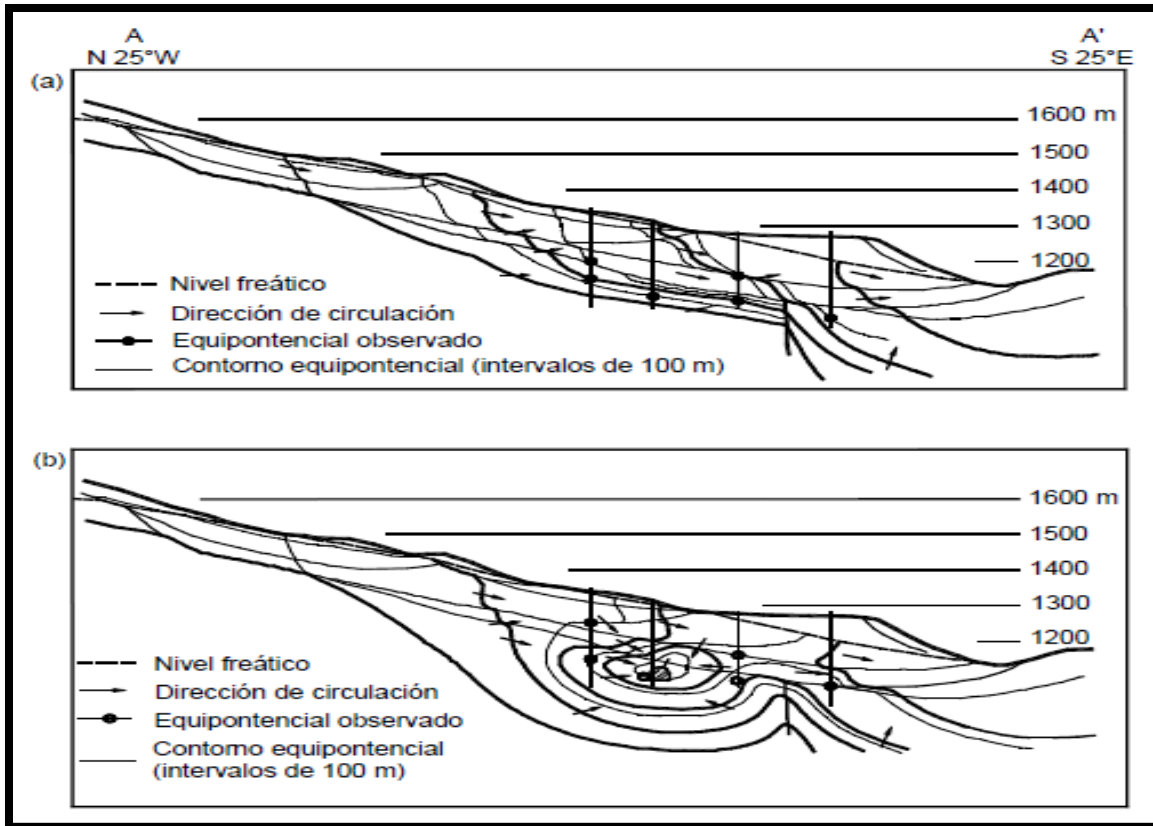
Efecto de una galería de drenaje sobre las líneas piezométricas en un gran deslizamiento. (a) Antes de la galería. (b) Después de construida la galería.
